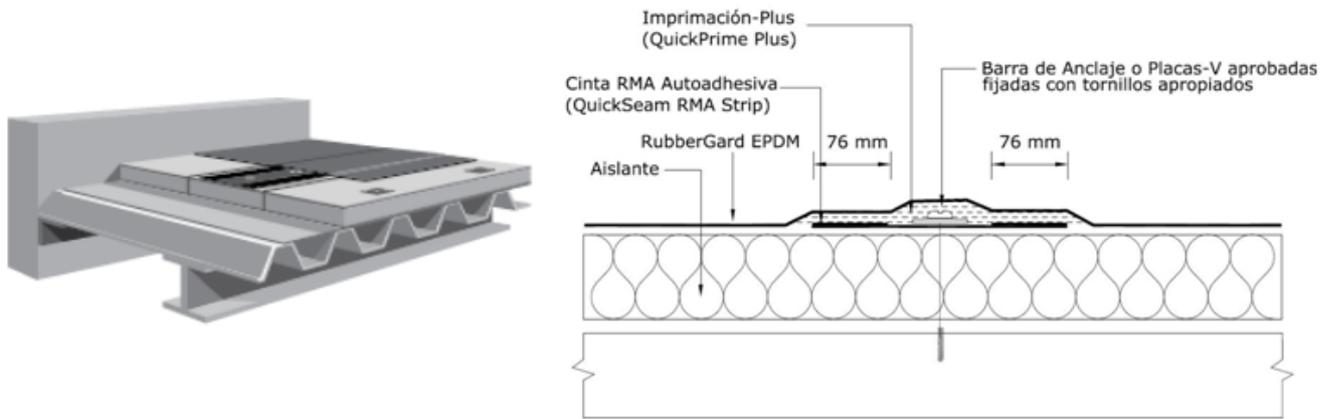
Detalle del sistema fijado mecánicamente MAS
